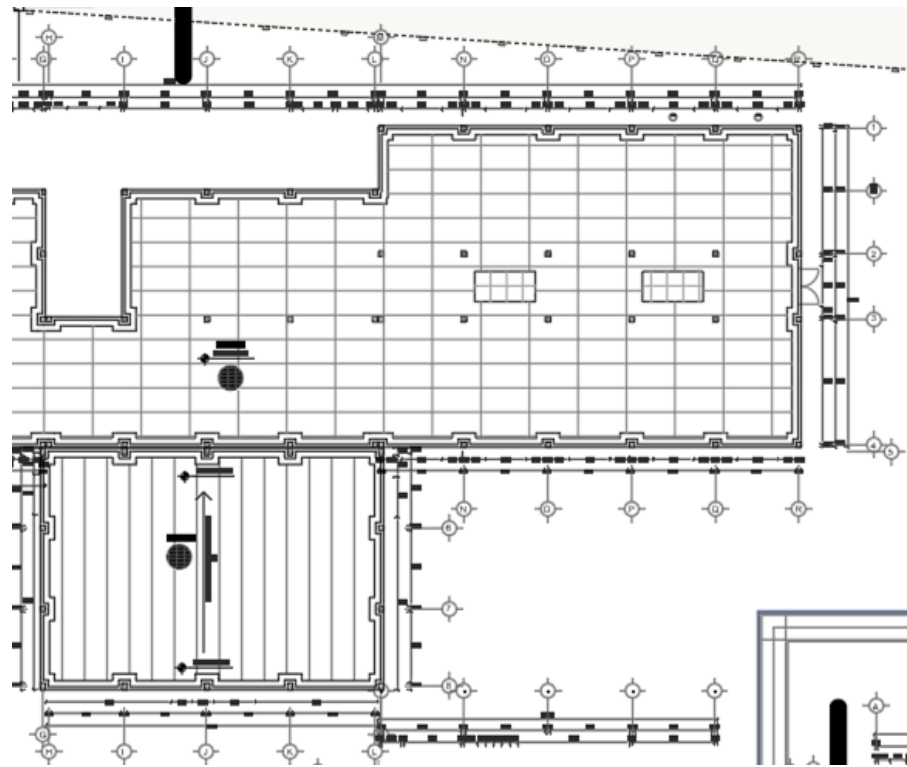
Plano de Techos - Zona de Consulta Externa - Bloque 03. Elaboración propia.
